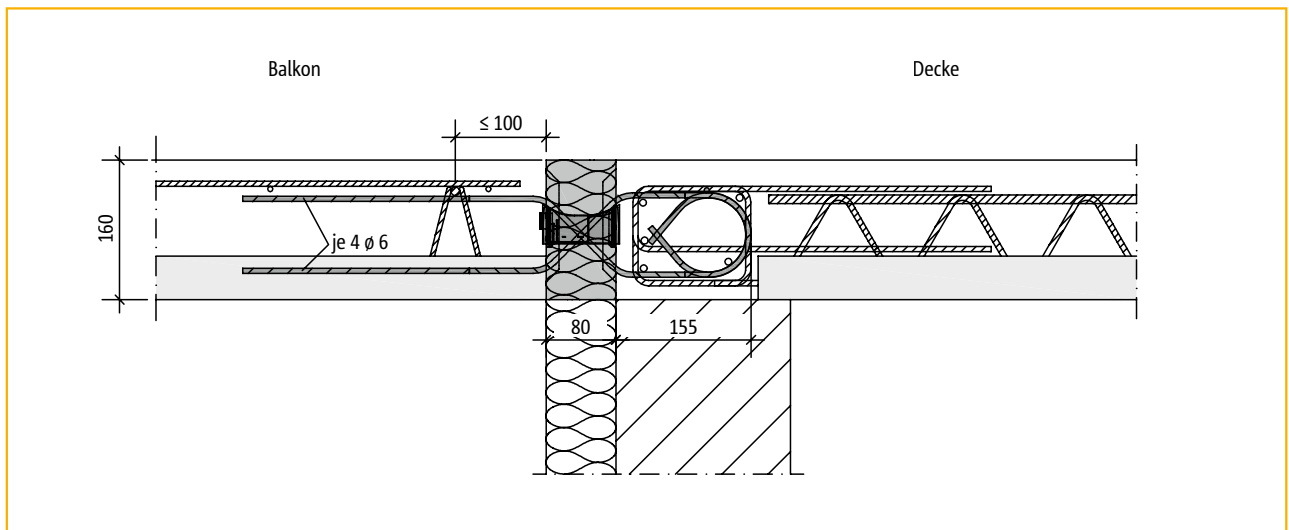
Einbausituation „Elementdecken“ mit Schöck Isokorb® Typ Q10+Q10-H160
